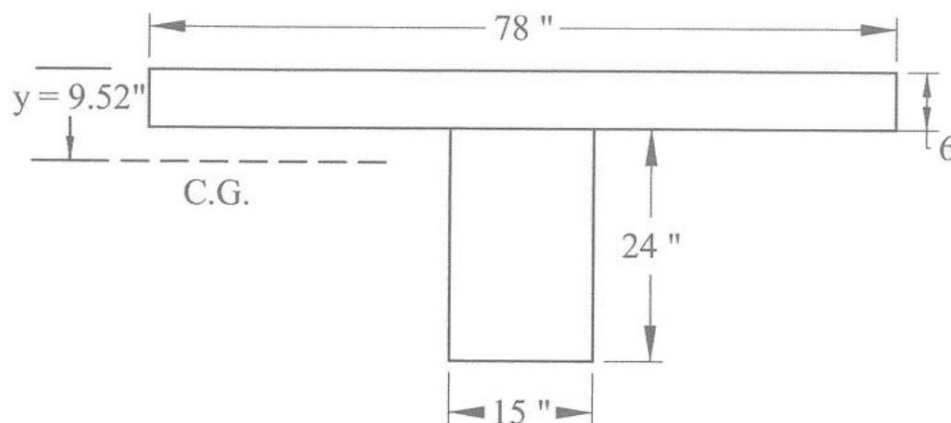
A.5-1 Sección transversal de una viga en T de hormigón: profundidad al centroide de la sección no fisurada
